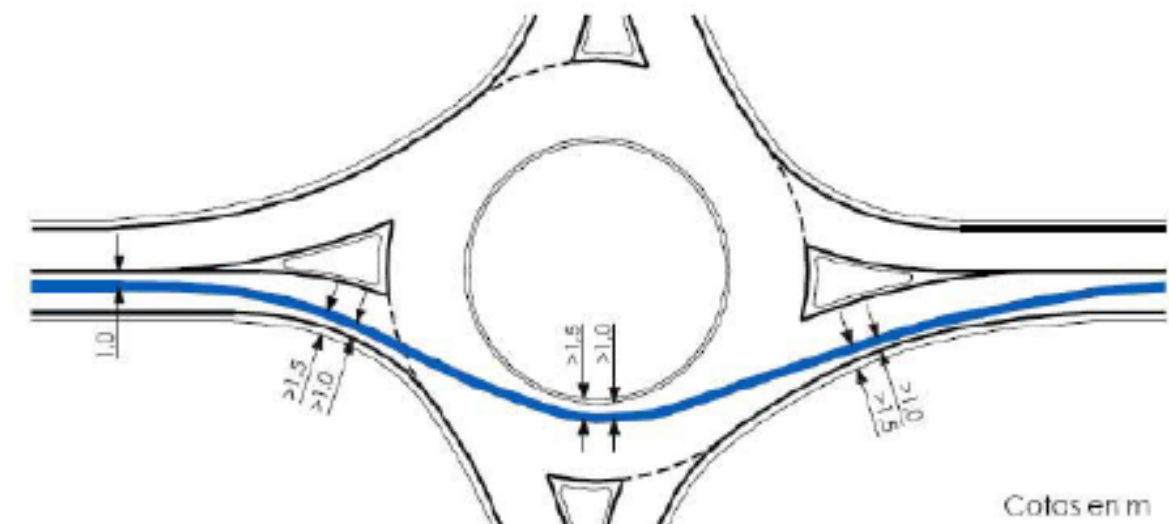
Instrucción de Carreteras 3.1. - IC
